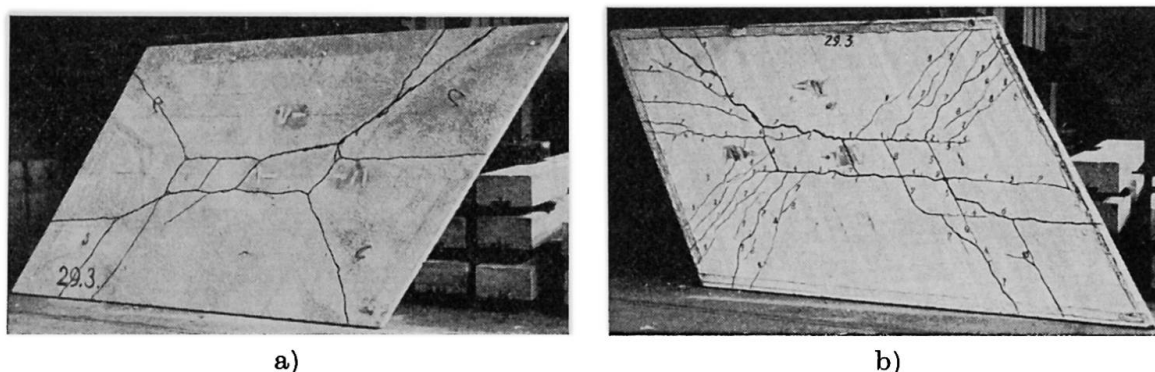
Fissures sur la face a) supérieure, b) inférieure de la dalle oblique simplement appuyée le long du pourtour. Dalle n° 6.
